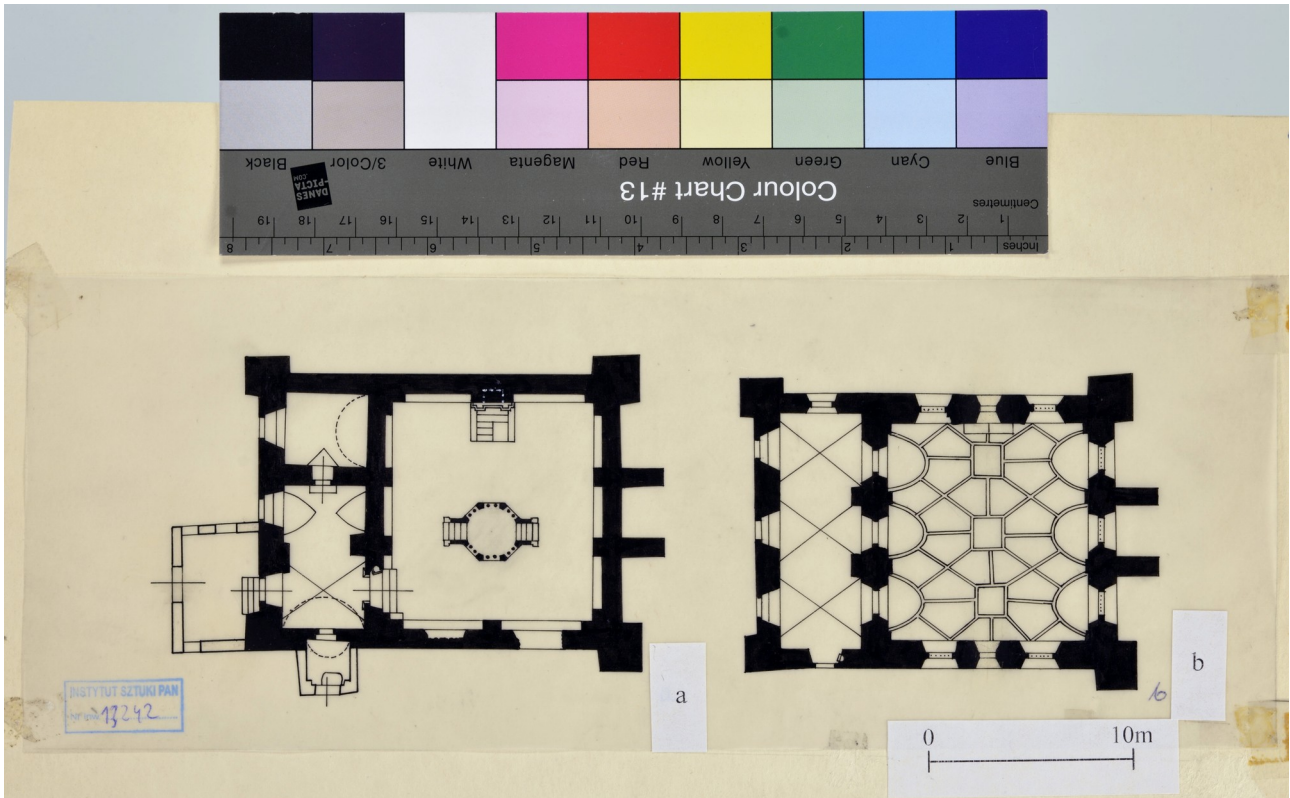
Synagoge- Aufbau und Struktur- Grundriss EG
